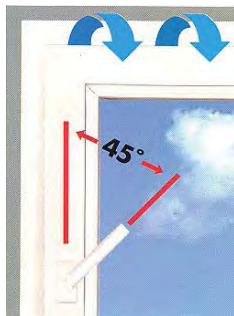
ABERTURA OSCILANTE de 5 mm para la entrada regulada de aire fresco con la manija de la Cremona posicionada a 45°
